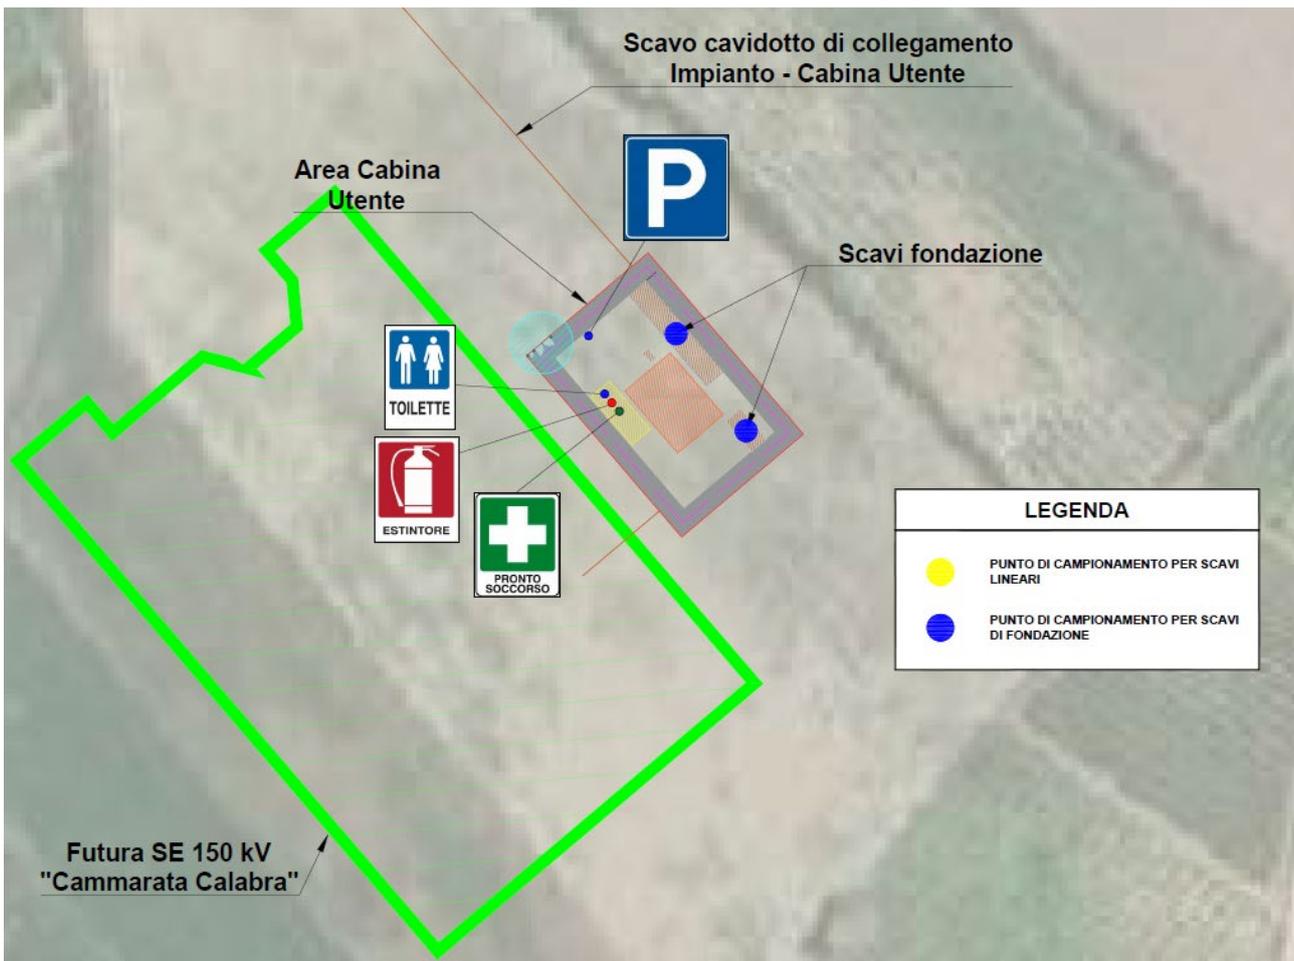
Layout impianto con piano di campionamento – Area Cabina Utente
